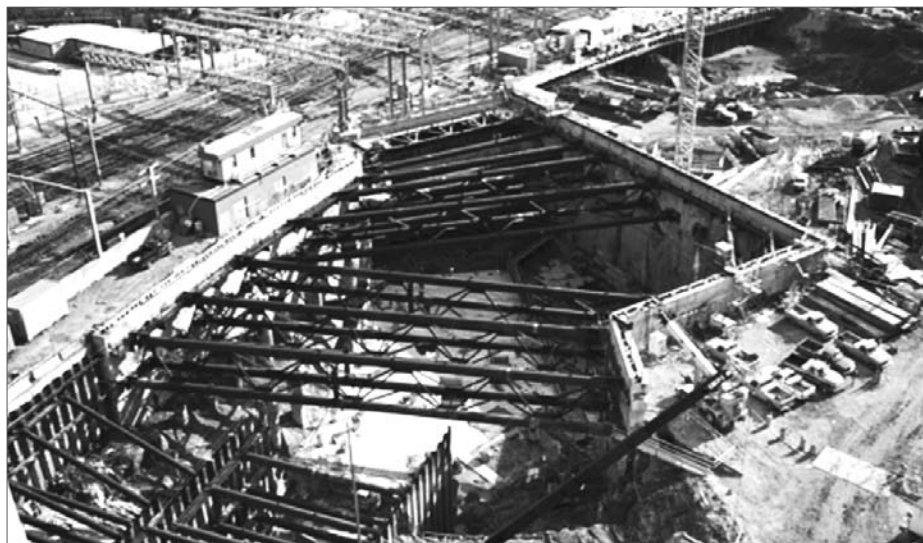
Строительство тоннеля открытым способом «стена в грунте» (<http://scholarsmine.mst.edu>)
